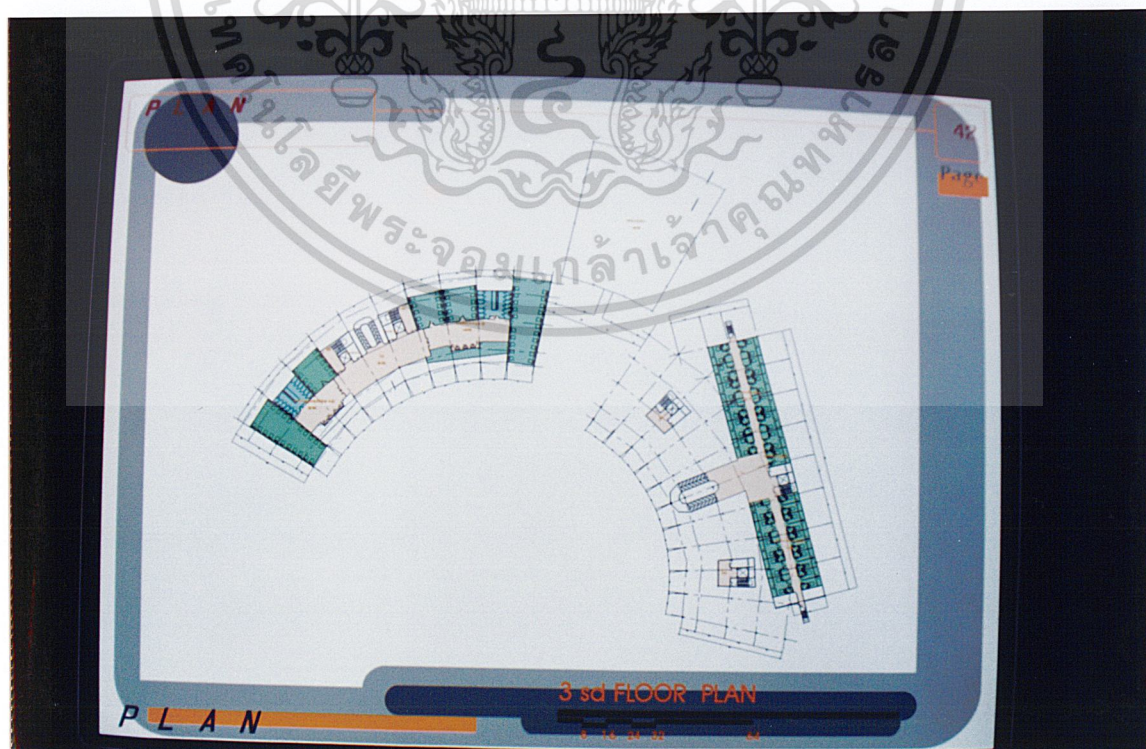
แพลนพื้นชั้น 3 อาคารสำนักงาน นันทนาการ บริการการแพทย์ (3 ND FLOOR PLAN)
